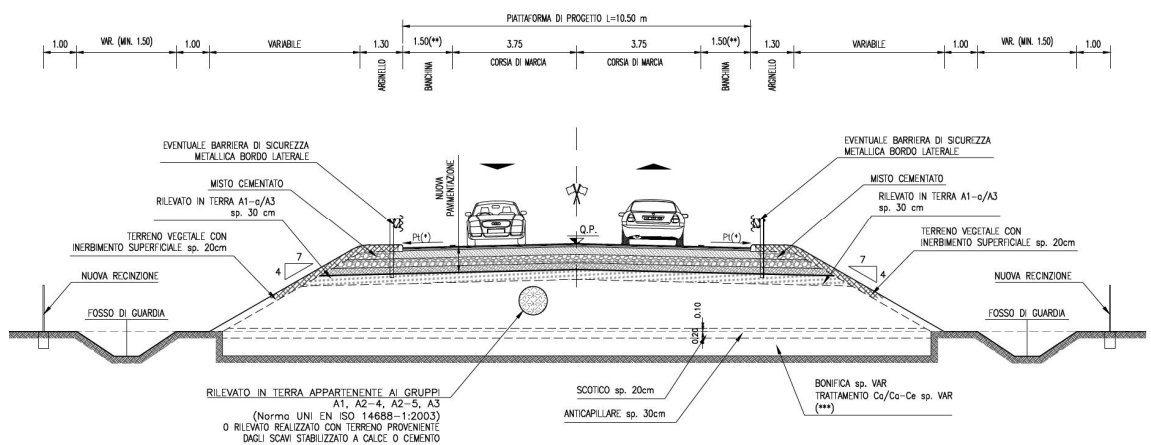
Sezione tipo rampa bidirezionale in rilevato
